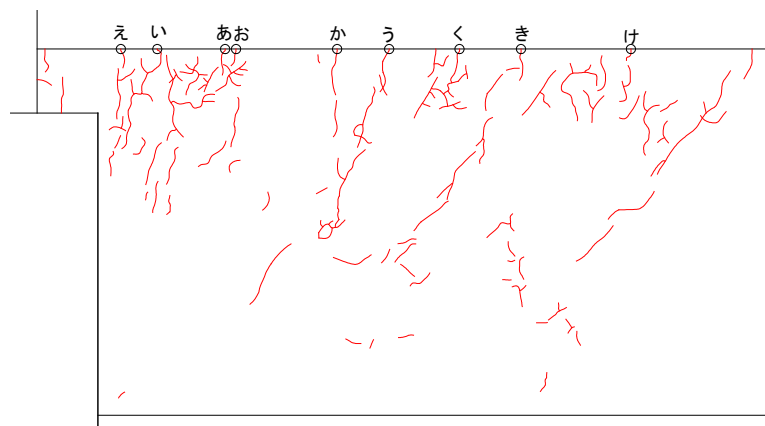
基礎梁ひび割れ幅測定位置(試験体 A-7b 負荷荷)
